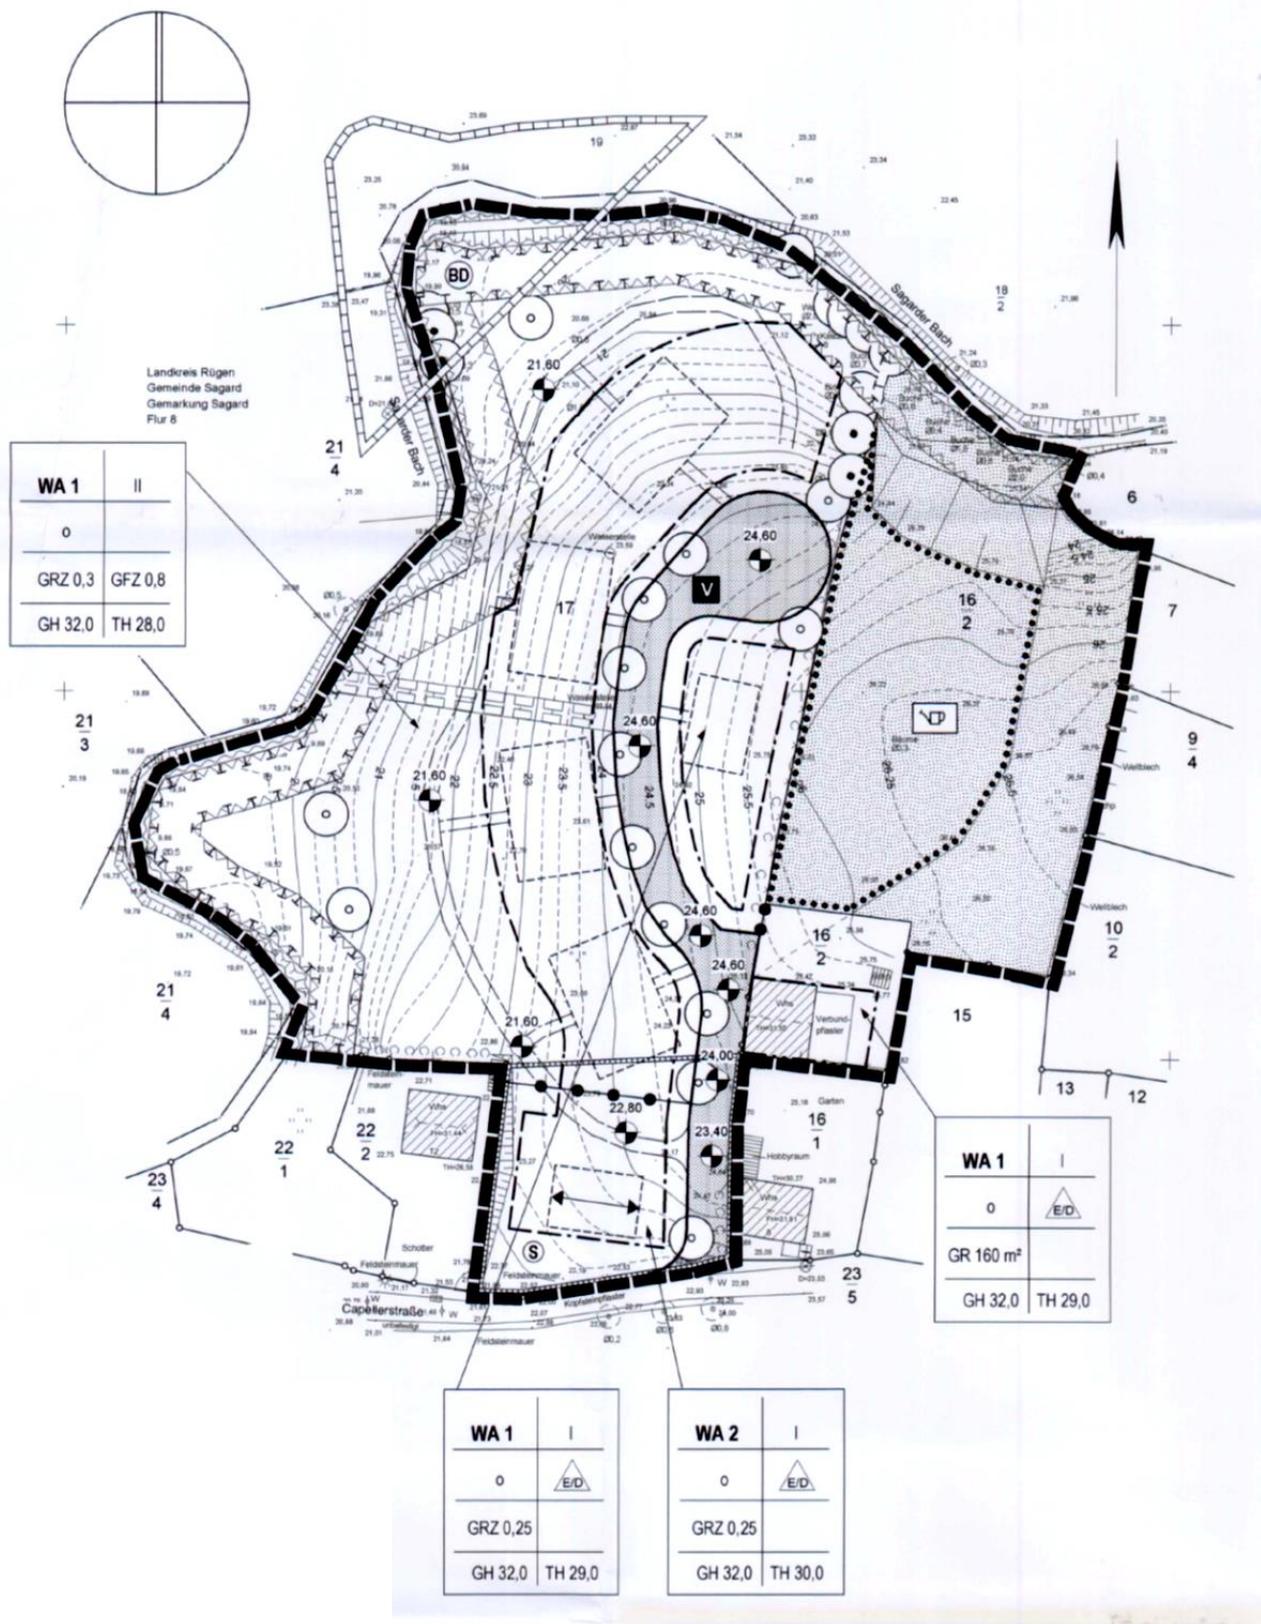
Ursprungsplan, Planzeichnung ohne Maßstab
